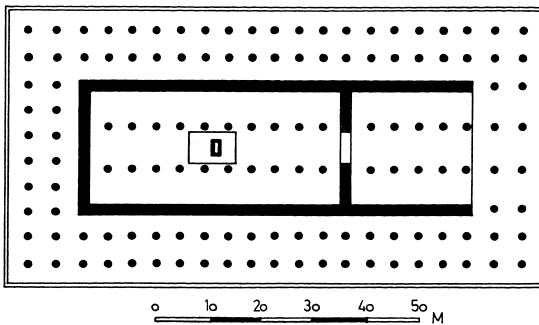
Samos. Heraion III. Grundriss (H. Knell, Grundzüge der griechischen Architektur [1980] Abb. 55)
